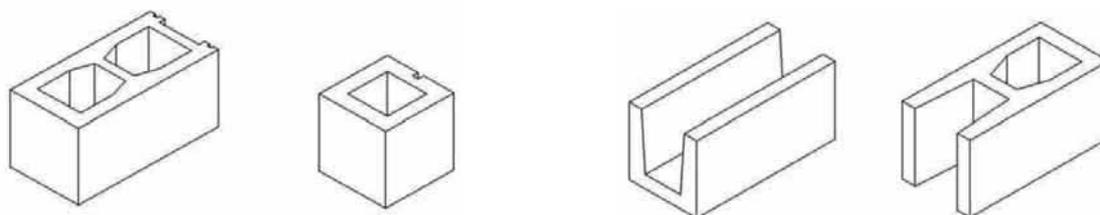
Bloque de esquina/cabeza lisa y medio bloque de árido denso [izquierda]. Bloques en "U" para crear zunchos o vigas de hormigón armado [derecha].
